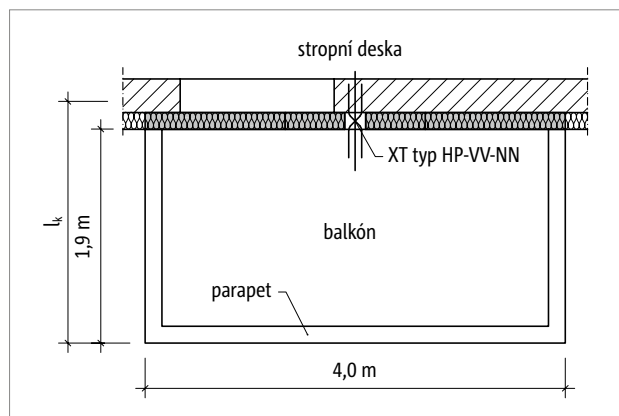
Schöck Isokorb® XT typ HP-VV2-NN1: Půdorys prvku
